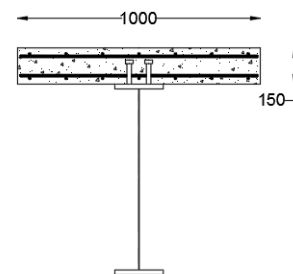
Secção tipo das vigas do ensaio MI 3
